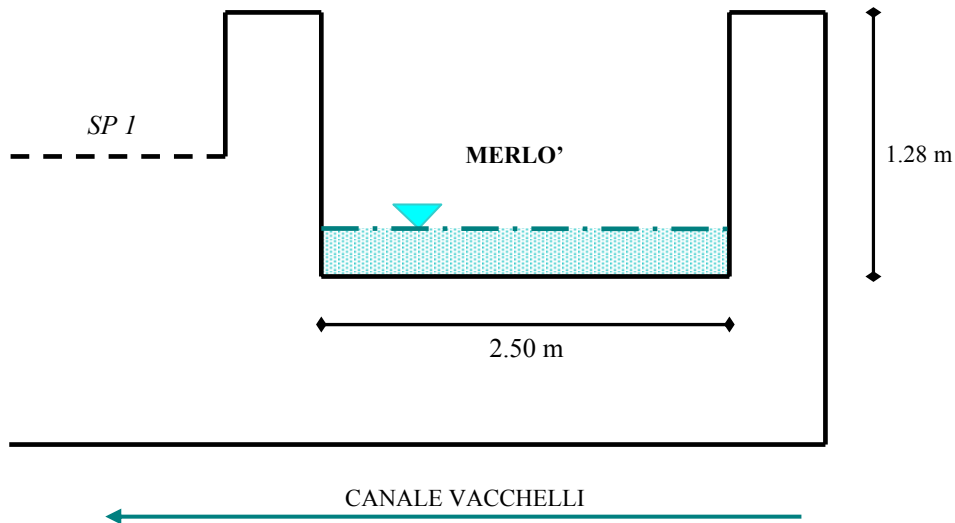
Schema della geometria della Sezione 5 sul Merlò.
